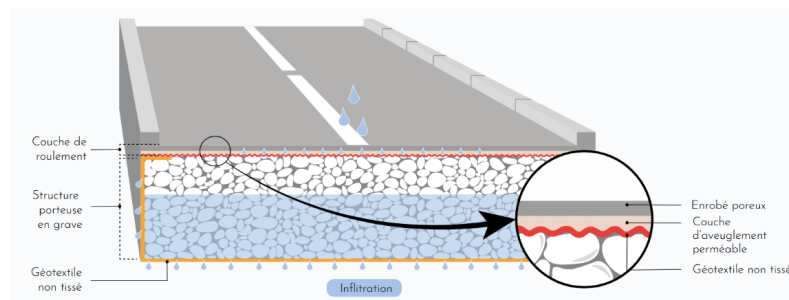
Schéma en profil d'une chaussée à structure réservoir
